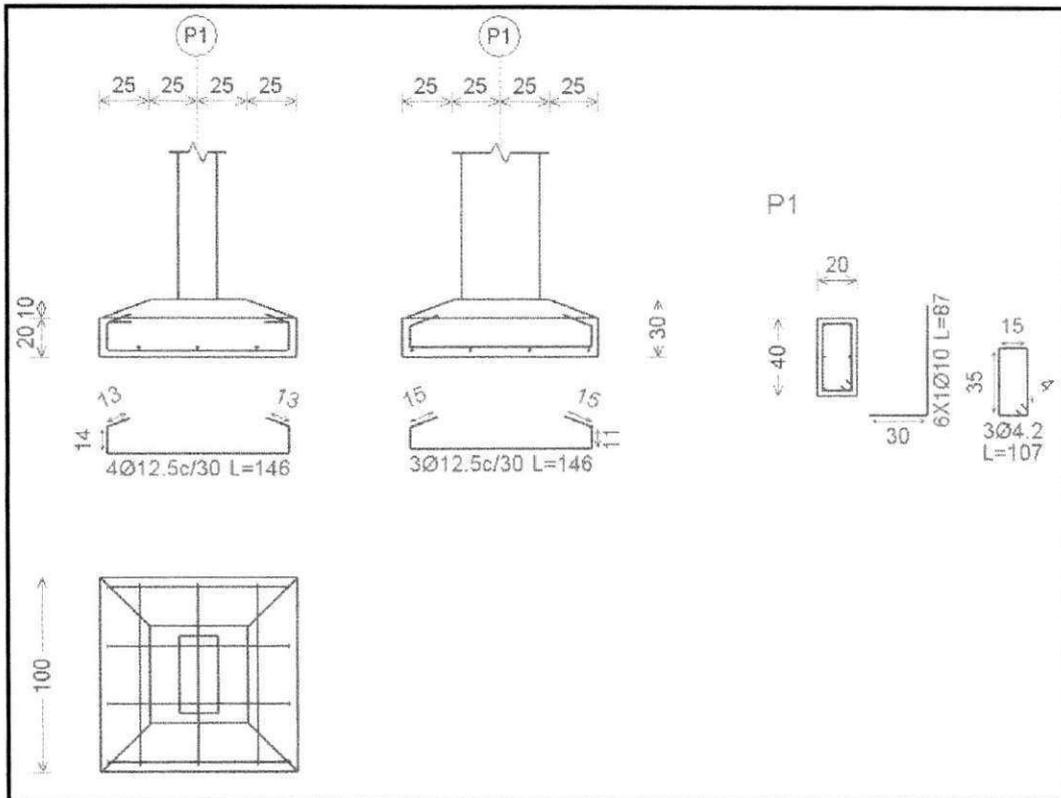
Detalhamento da sapata do pilar P1 (dimensões em cm)
